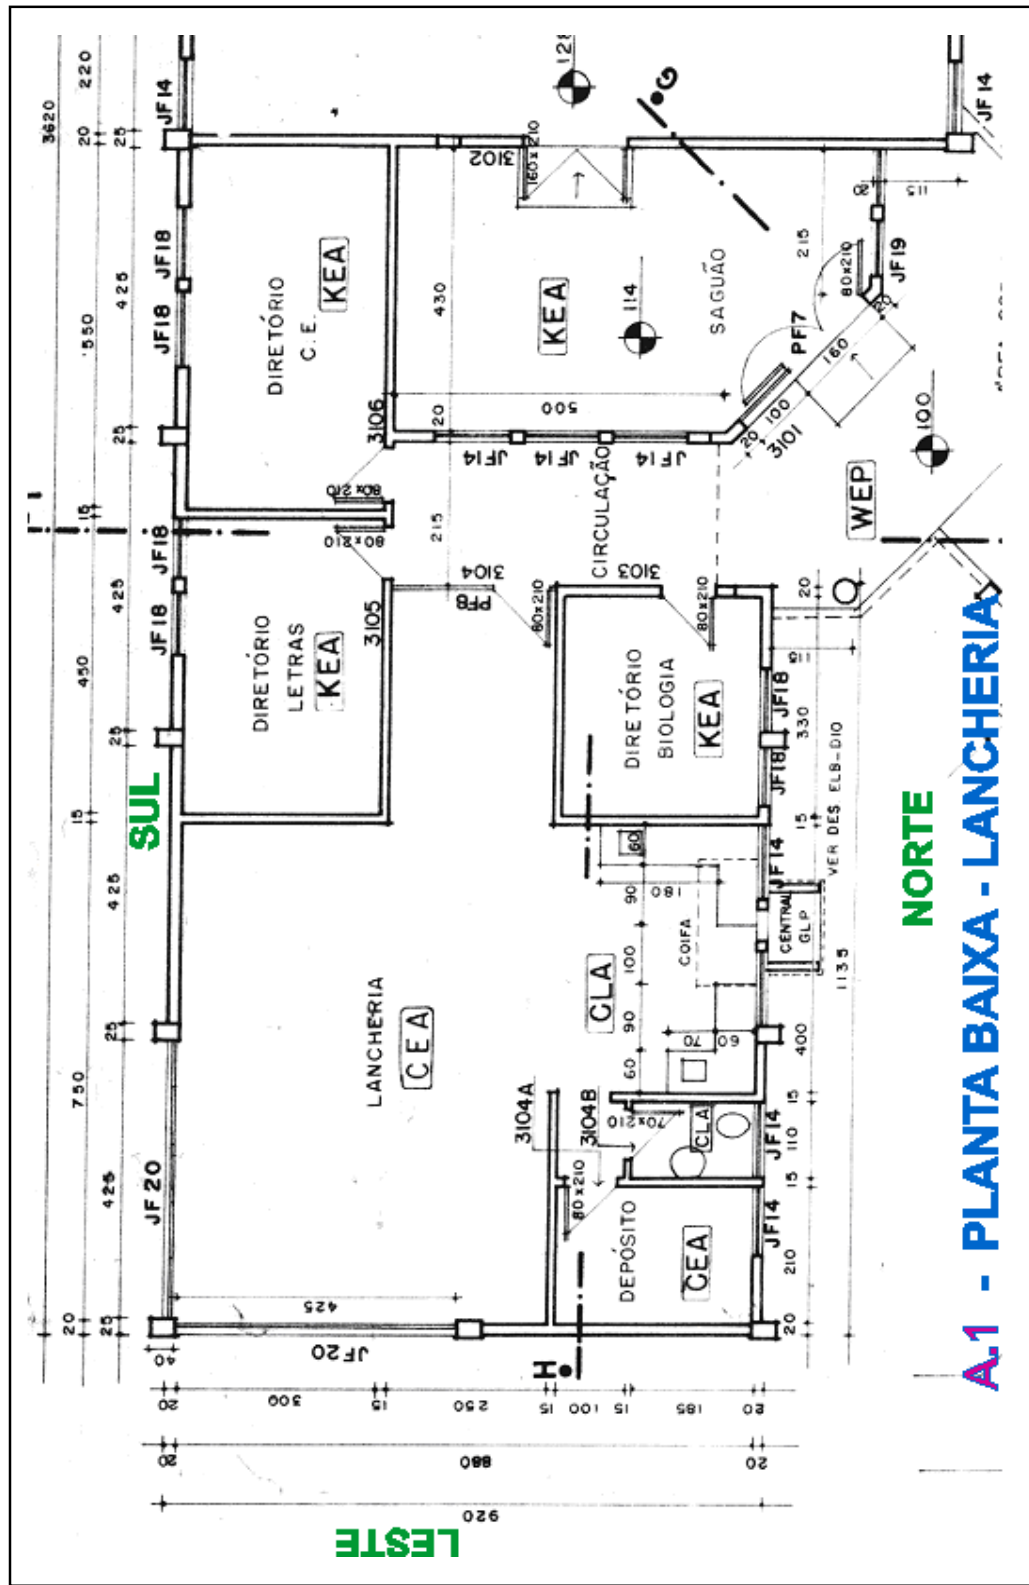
Planta baixa setor Lancheria (ISAIA, 2001, p. 32)
